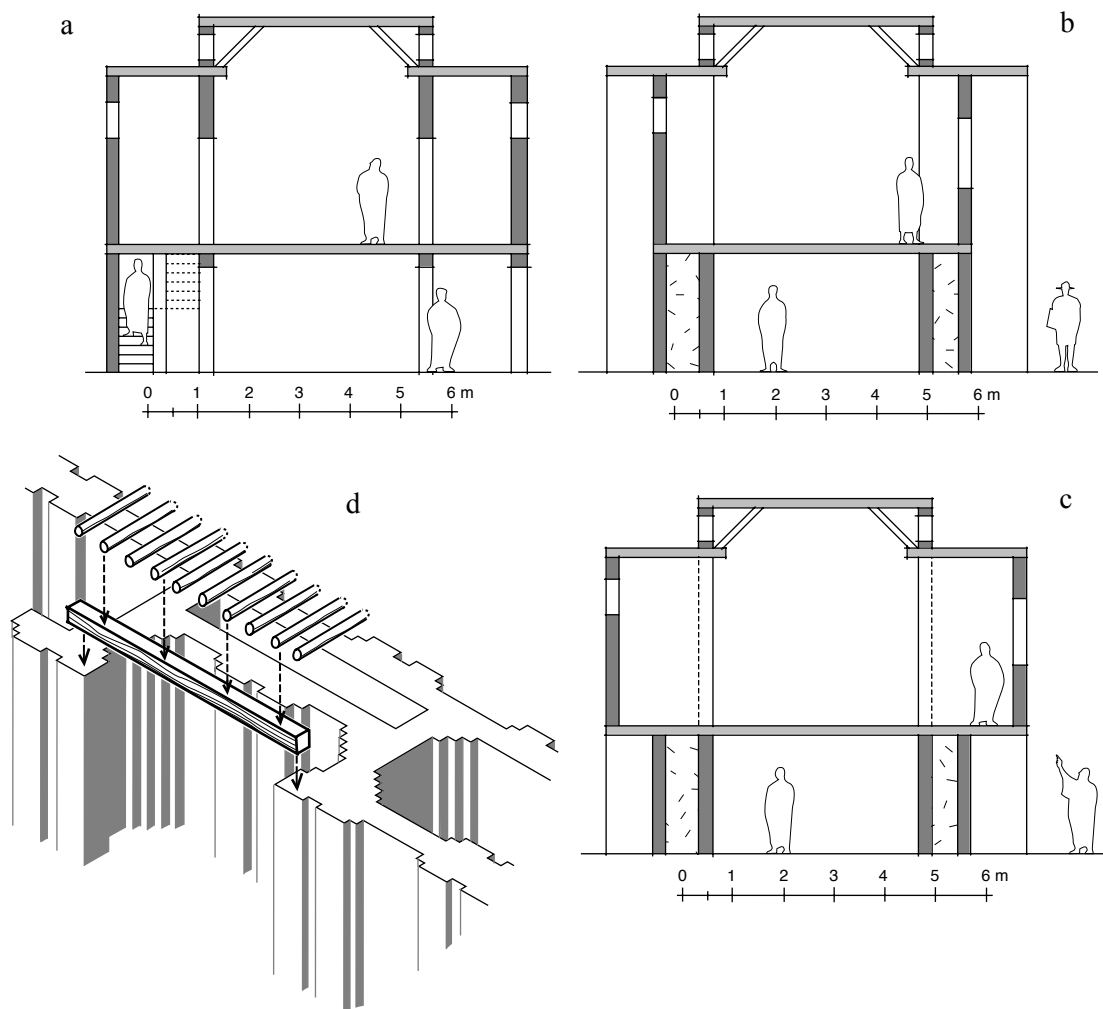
coupes au travers du « Bâtiment septentrional ». En a : coupe passant par l'escalier et la porte d'entrée. En b : coupe passant par le centre à l'emplacement des fausses pièces selon l'hypothèse du strict report en altitude du plan au sol. En c : schéma de l'organisation structurale du contact entre le sommet de la niche centrale du niveau inférieur et le sol de l'étage, éventuellement utilisé comme balcon. En d : coupe selon l'hypothèse d'une pièce se trouvant au-dessus de la niche et ouverte sur la place par une fenêtre à balcon (NB).
